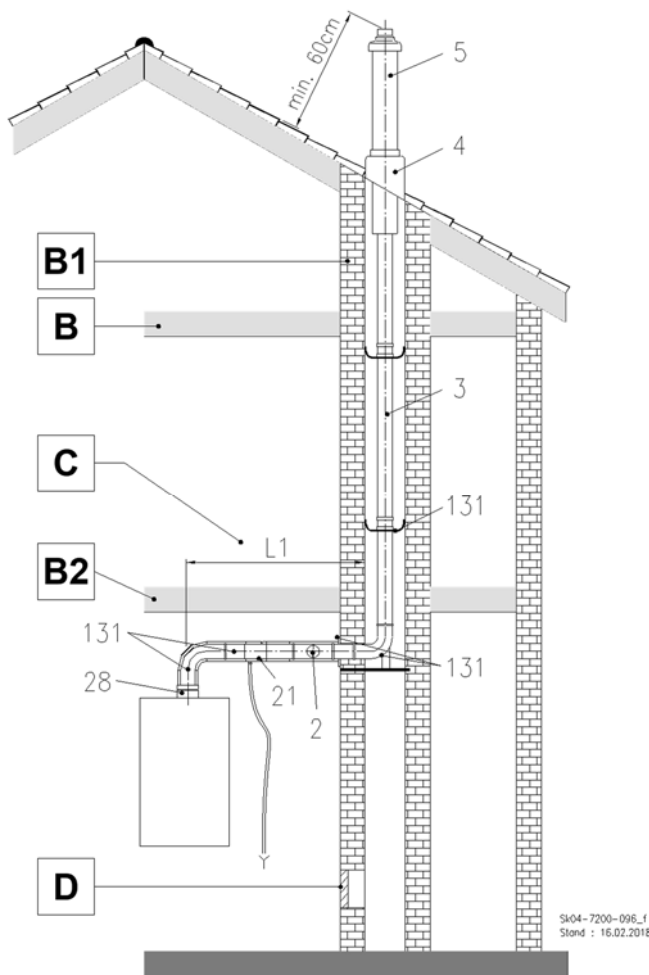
C_{93x} Luft-Abgas-System im Schacht und Luft-Abgas-Rohrsystem mit Dachdurchführung
